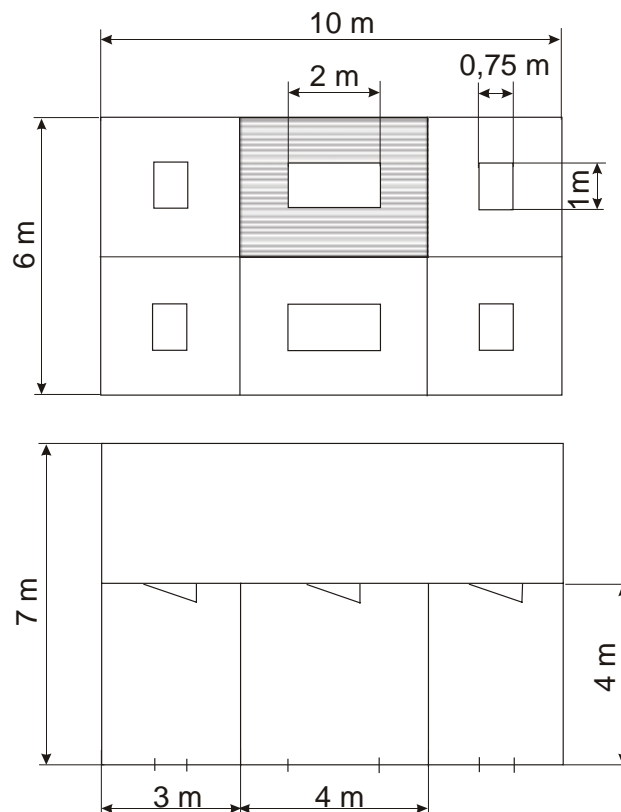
Grundriss und Aufriss der Südansicht des Testhauses, die Kollektorfläche ist schraffiert dargestellt
